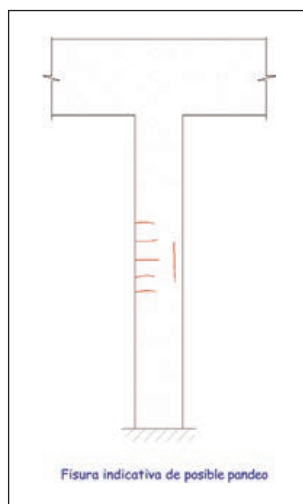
FISURACIÓN POR PANDEO.
